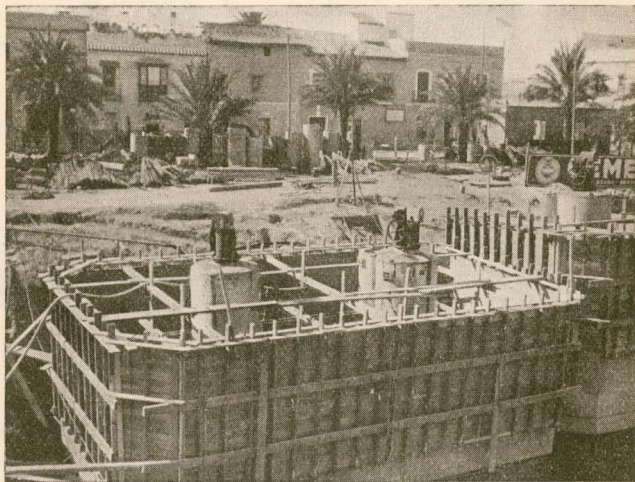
Lanzamiento de un cajón del puente de San Telmo.
